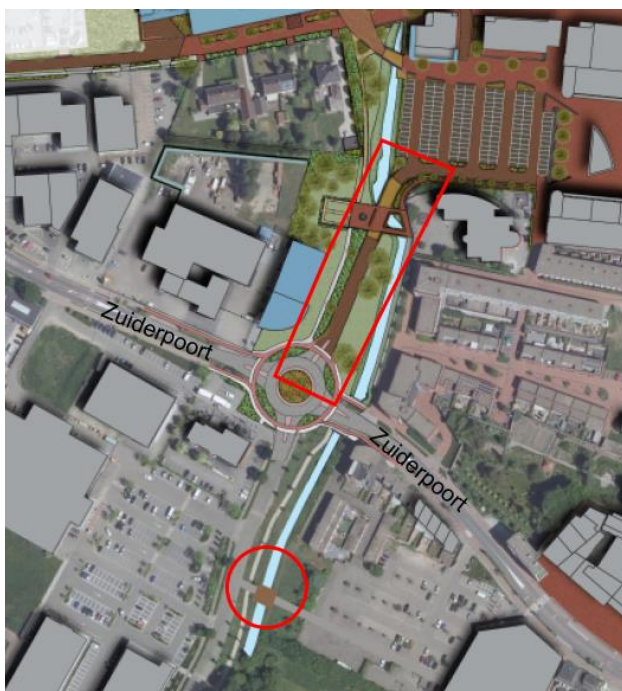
Impressie van het plangebied met bovenaan het zuidelijk deel en onderaan het noordelijk deel van het plangebied.
